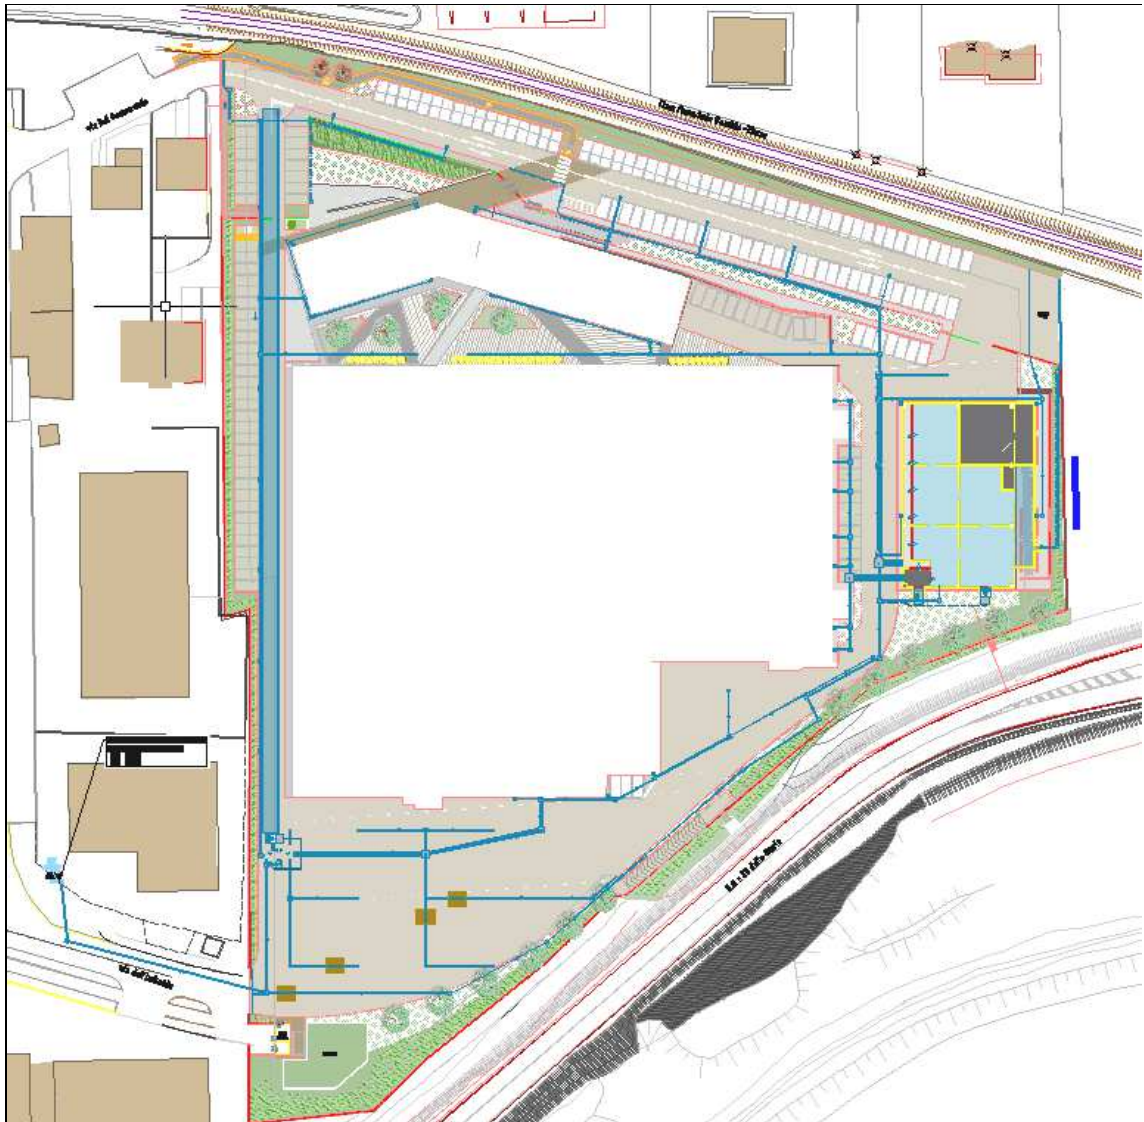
Stralcio planimetria reti meteoriche – Elab. 00PC_OU_B002_20_4929
